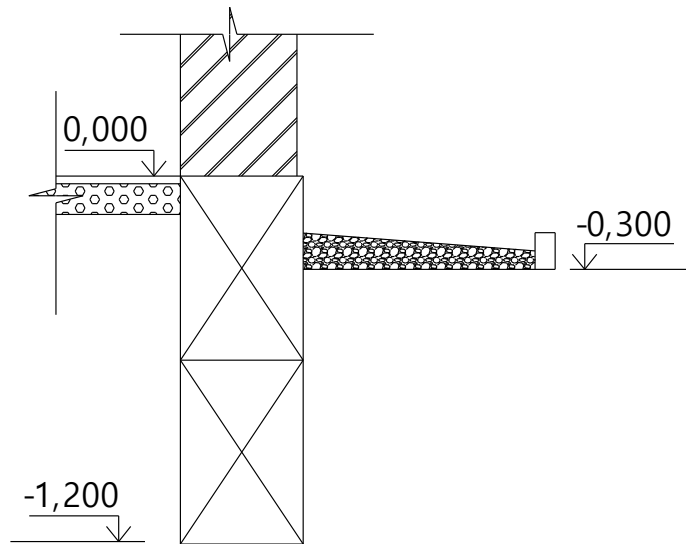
Конструкція фундаменту під крайню стіну по осі 1
